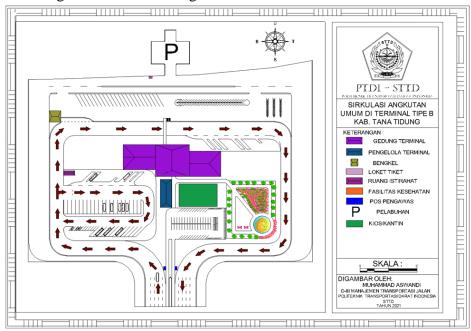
layout Usulan 2 Fasilitas Terminal tahun ke-5 (2029)
